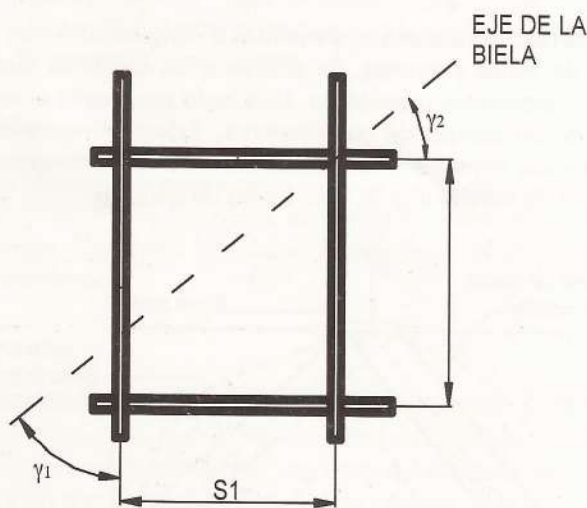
Capas de armadura adicional en las bielas (Ref [2])
